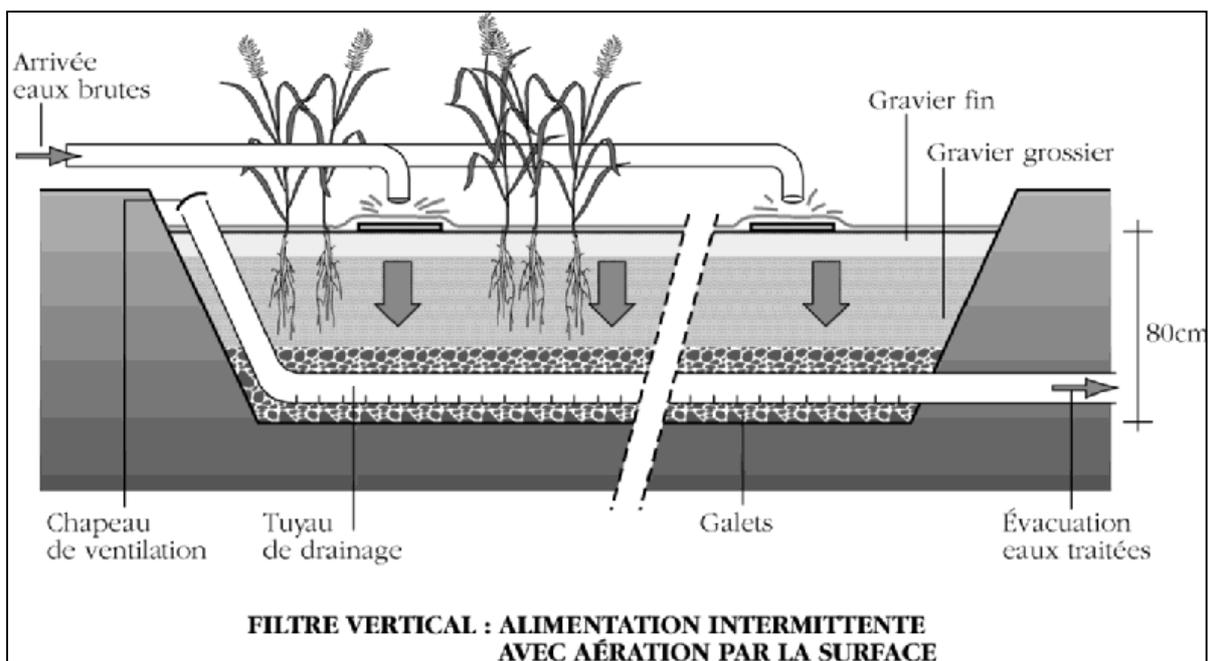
Schéma d'un filtre vertical (deuxième étage) en coupe transversale
